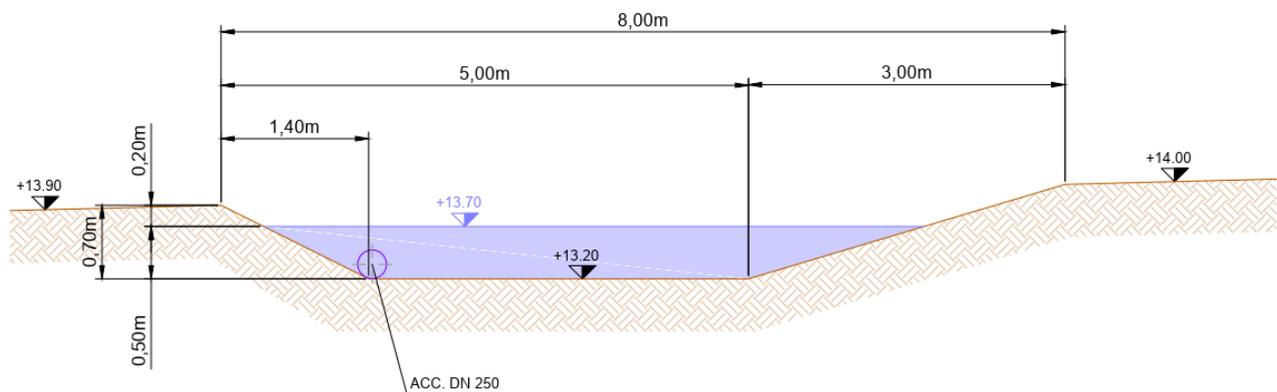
SEZIONE TIPOLOGICA BACINI DI ACCUMULO DI PROGETTO
